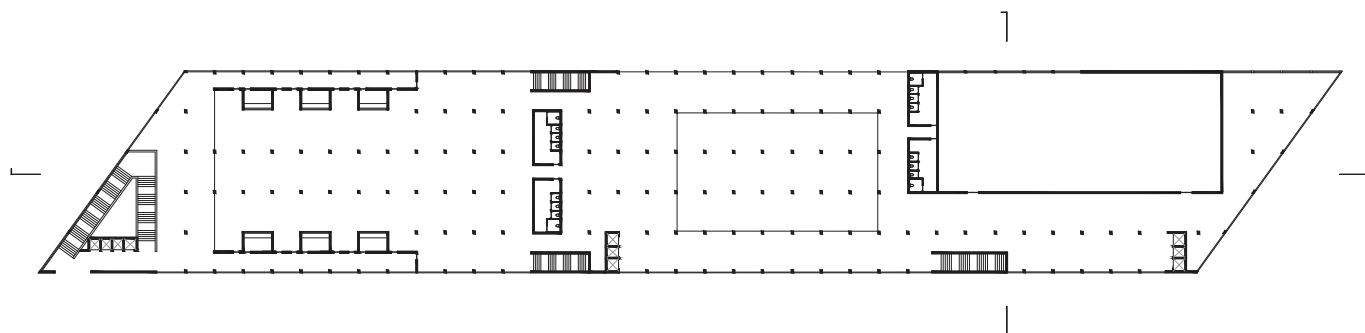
PLANTA DO PISO 2 DO TERMINAL DE CRUZEIROS
